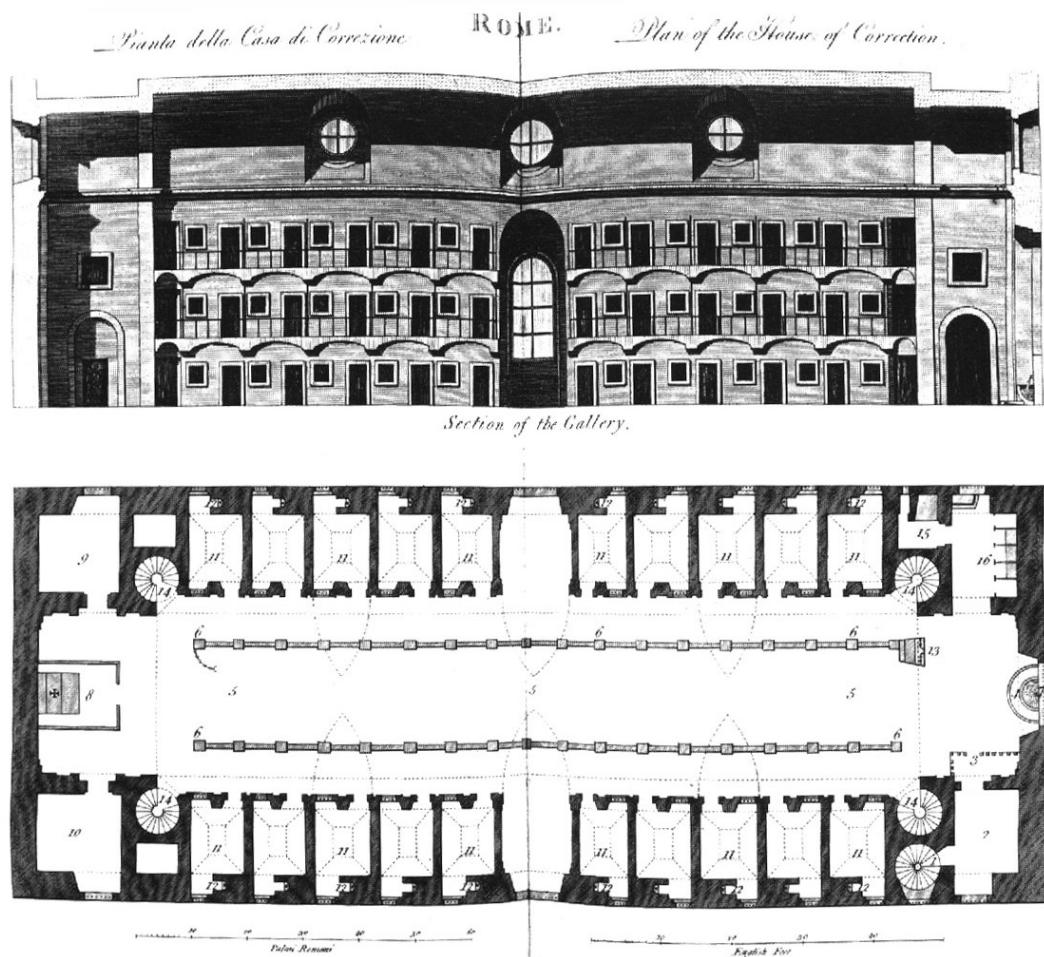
Prisão Papal San Michele, 1701; planta e seção longitudinal
